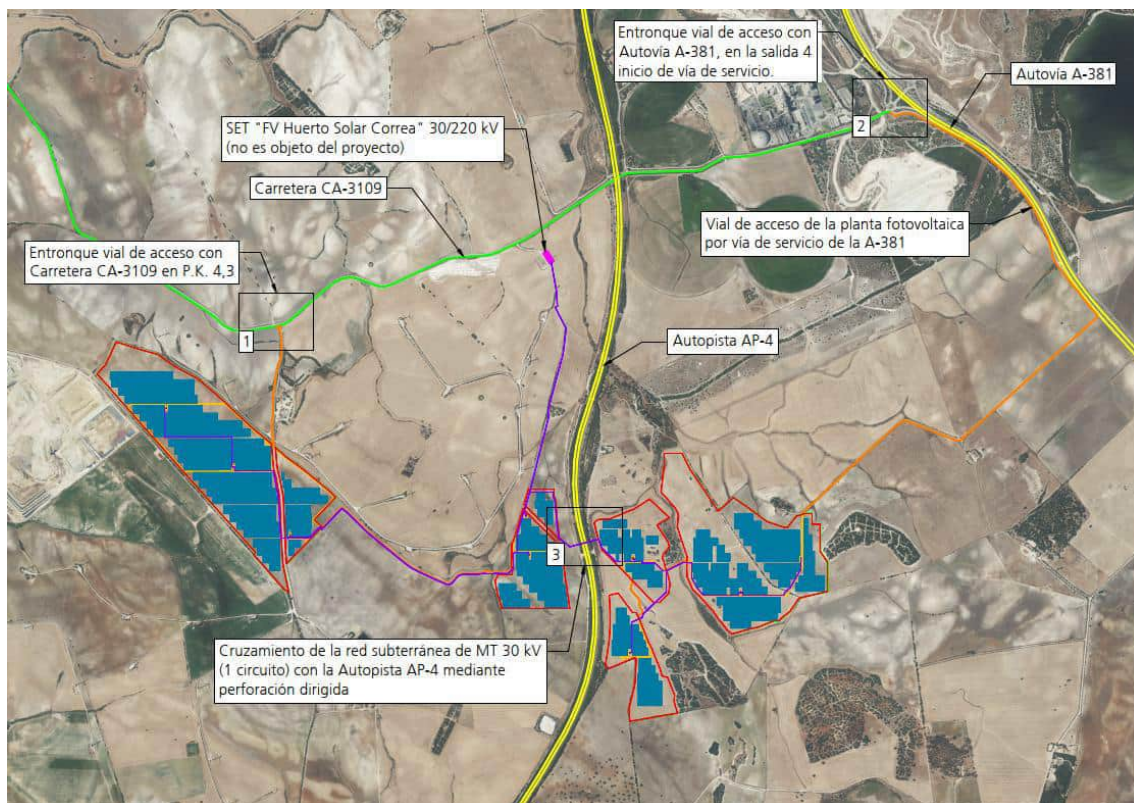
Situación infraestructuras viarias respecto a la planta fotovoltaica. Fuente: Elaboración Propia.
